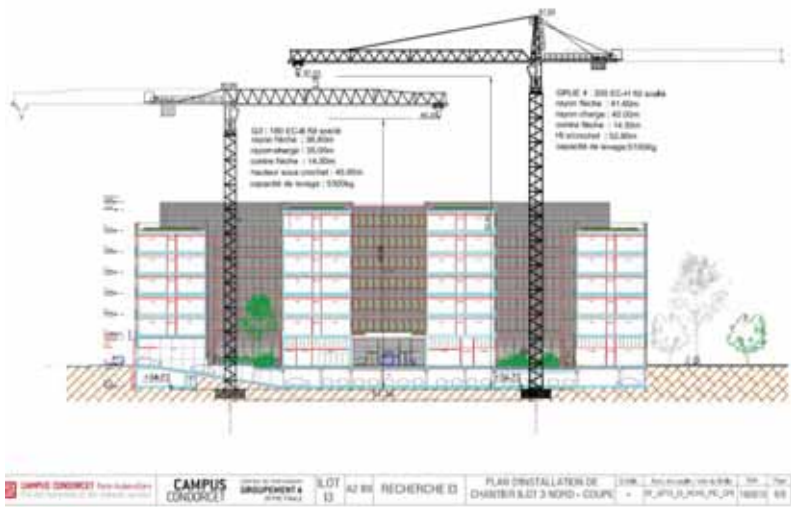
Plan d'installation de chantier Ilot 2 – Coupe (source : GROUPEMENT)
